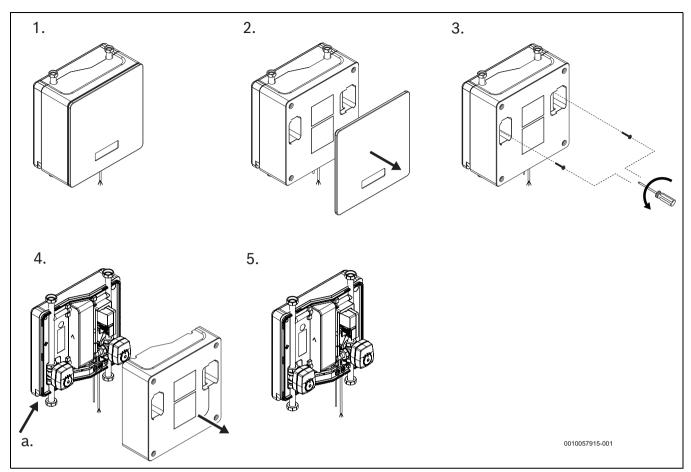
Préparer la station de refroidissement pour l'installation murale
